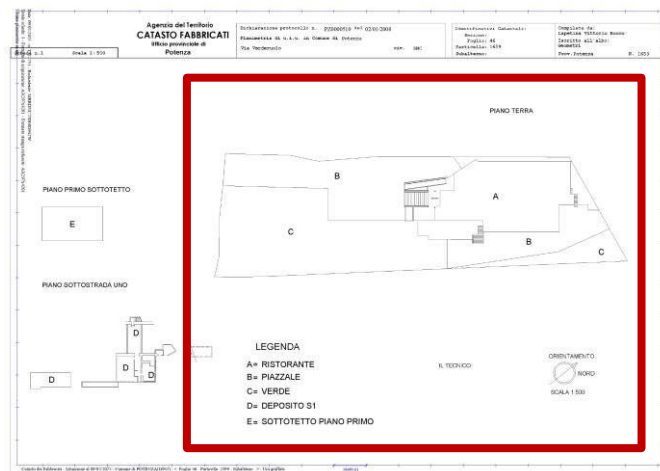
Planimetria Catastale Lotto Lu – Esterno (ALL. 06).
